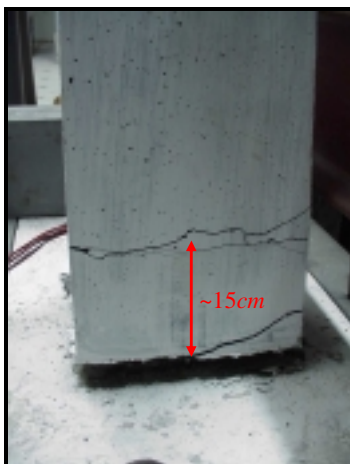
(a) - Fissuração da face traccionada do modelo M1G1.
